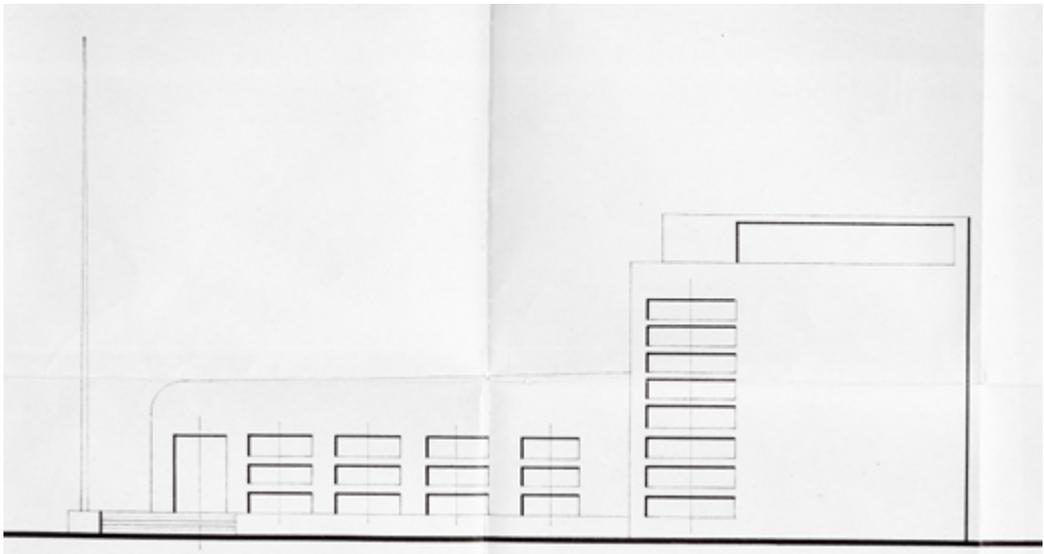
Prospetto laterale, primo progetto, 1937 (© Paolo Sanjust)
